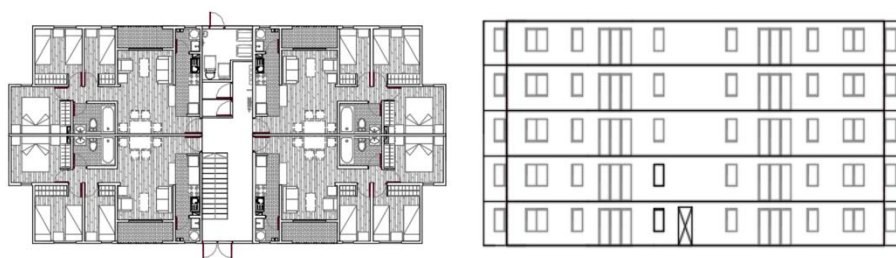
Vista en planta y fachada de la configuración arquitectónica tipo de 5 pisos
